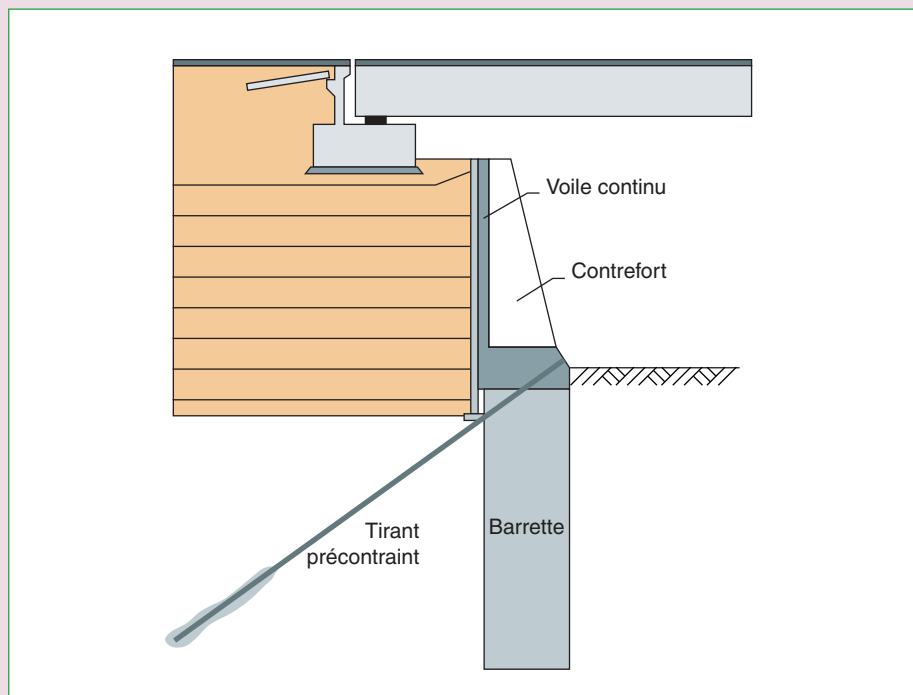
Renforcement par une poutre ancrée en pied d'ouvrage.
